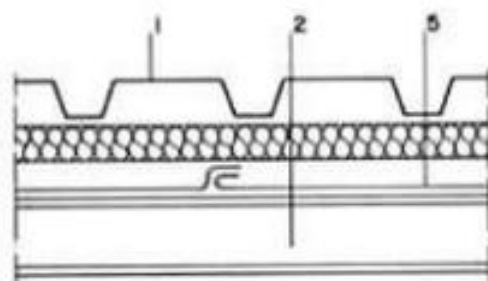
TIPOS DE TAPAMENTO COM TELHAS DE AÇO TRAPEZOIDAIS
